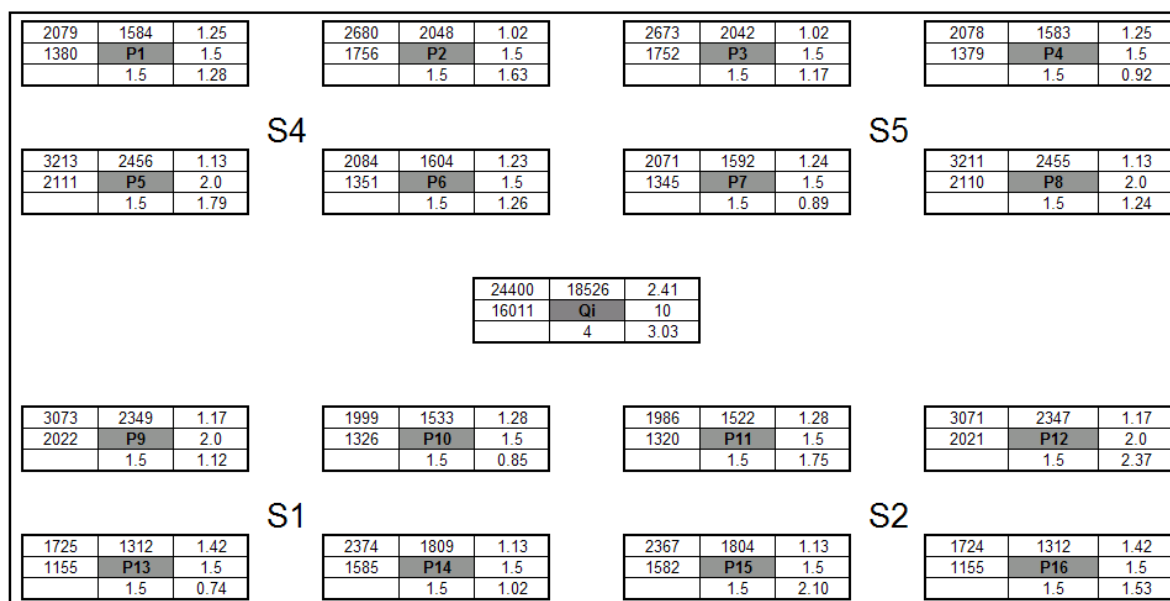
Planta esquemática e resultados (reações e assentamentos) das sapatas de fundação (apoio rígido).
